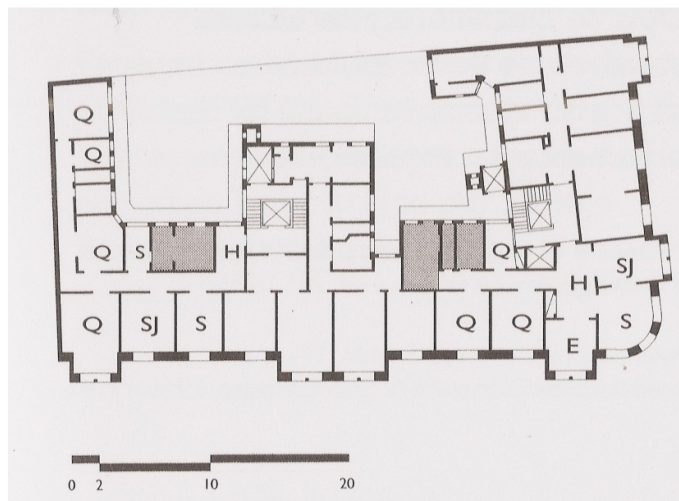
C – Planta baixa do pavimento tipo – Edifício Seabra – Praia do Flamengo
